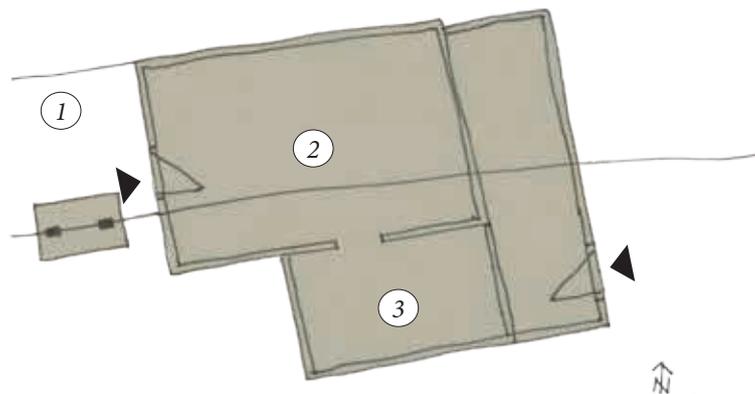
Grundriss Bergstation Materialseilbahn
